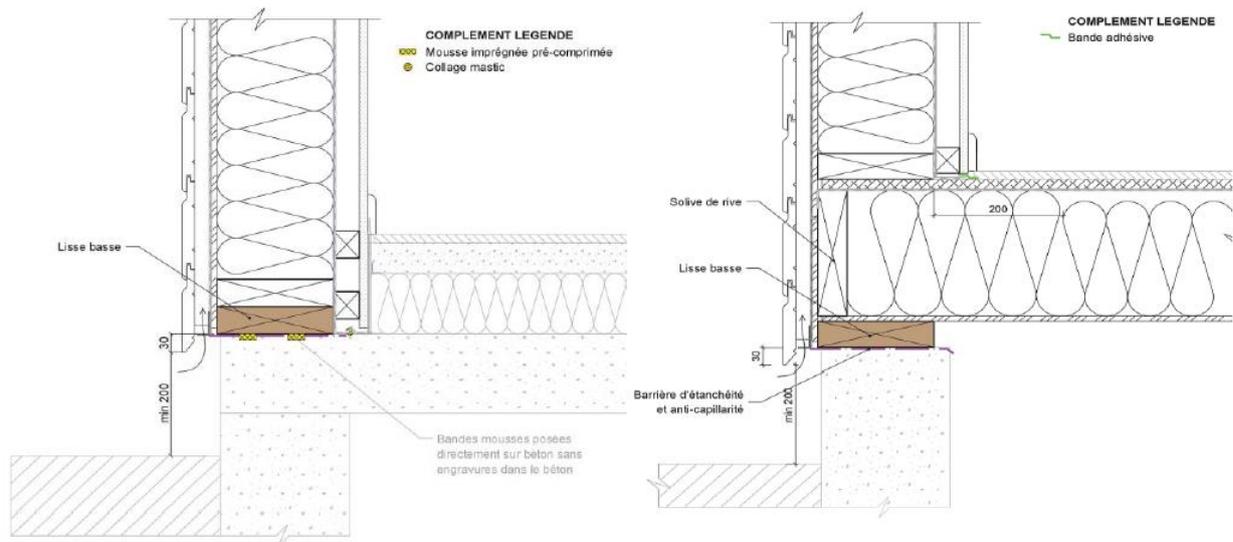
Exemple de positionnement de la lisse basse dans le cas d'un plancher béton et dans le cas d'un plancher bois (coupes verticales)
